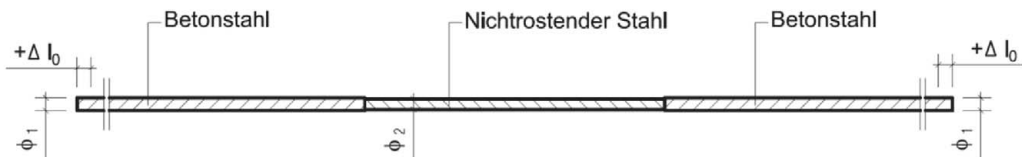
Druckelement aus Stahl mit beidseitig angeschweißtem Betonstahl, mit Durchmesserkombination, Tabelle A.1 gilt auch für dieses Druckelement aus Stahl
